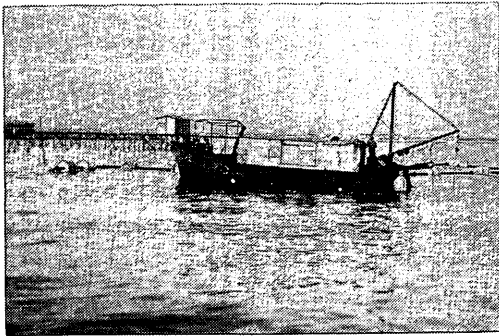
試験区域全景——小型ポンプ船による第1段載荷（敷砂）
